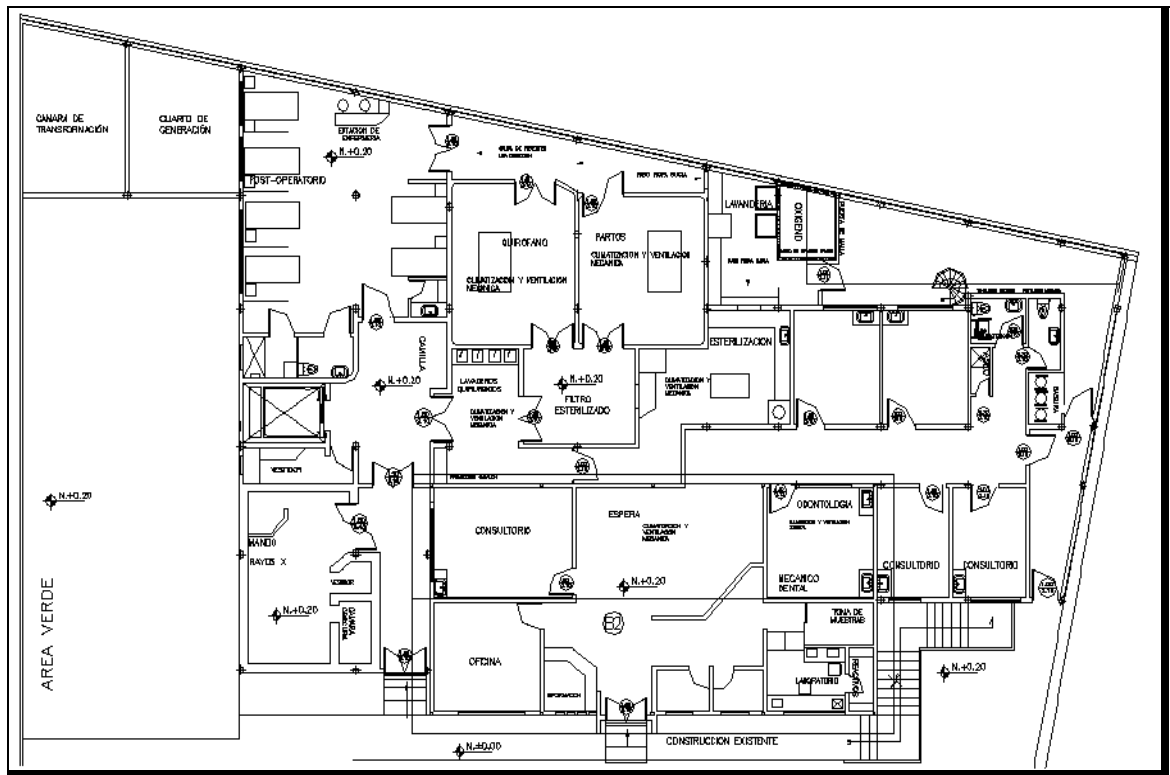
Planta baja Centro Médico “Cochapata”
